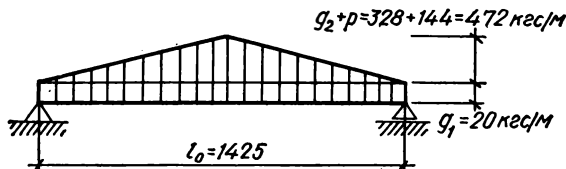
Расчетная схема поперечного ребра с комбинацией нагрузок 1.
